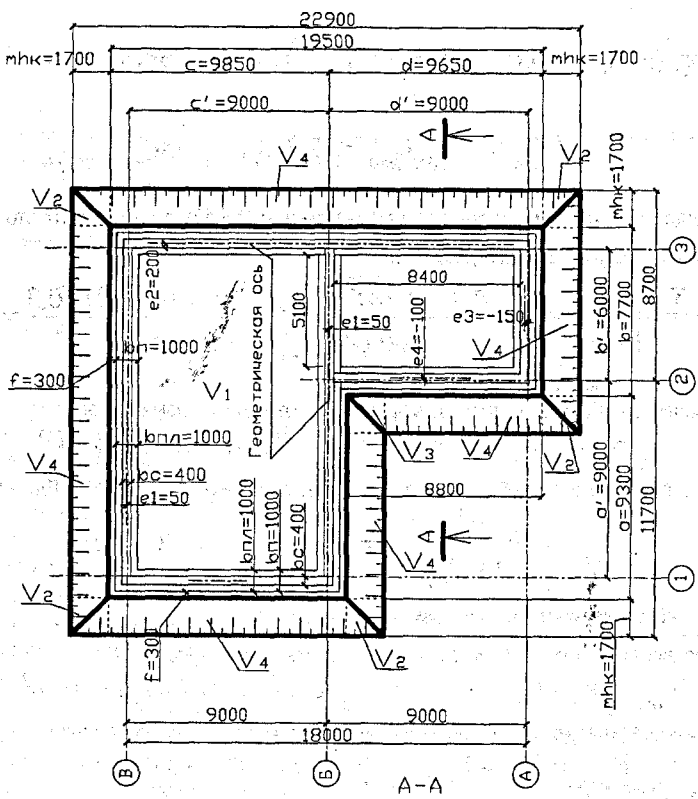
Схема к определению объемов земляных работ при разработке сложного котлована с одинаковой глубиной под сборные ленточные фундаменты ступенчатого сечения в песчаных грунтах
